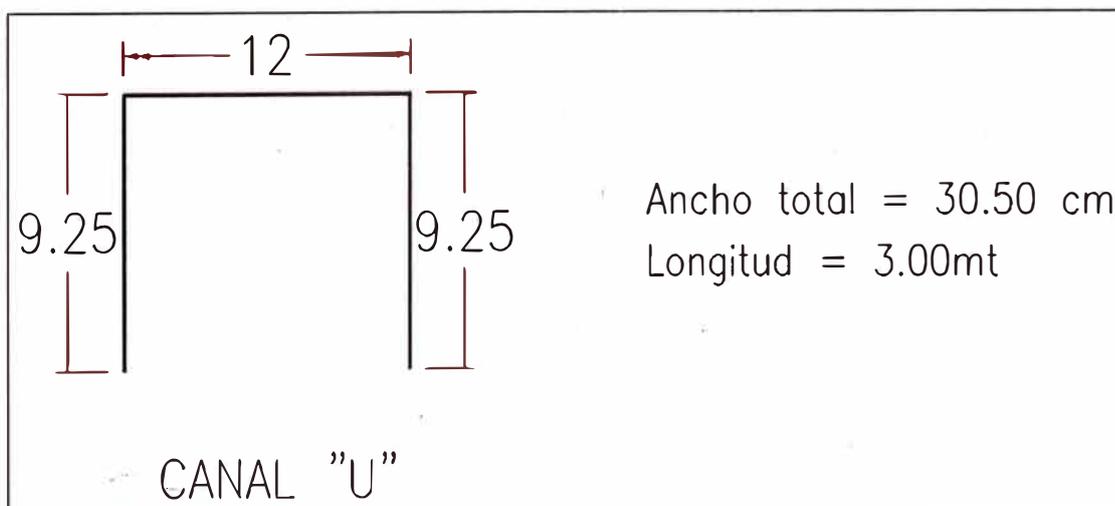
Sección de canal tipo U típico (Referencia 3)
